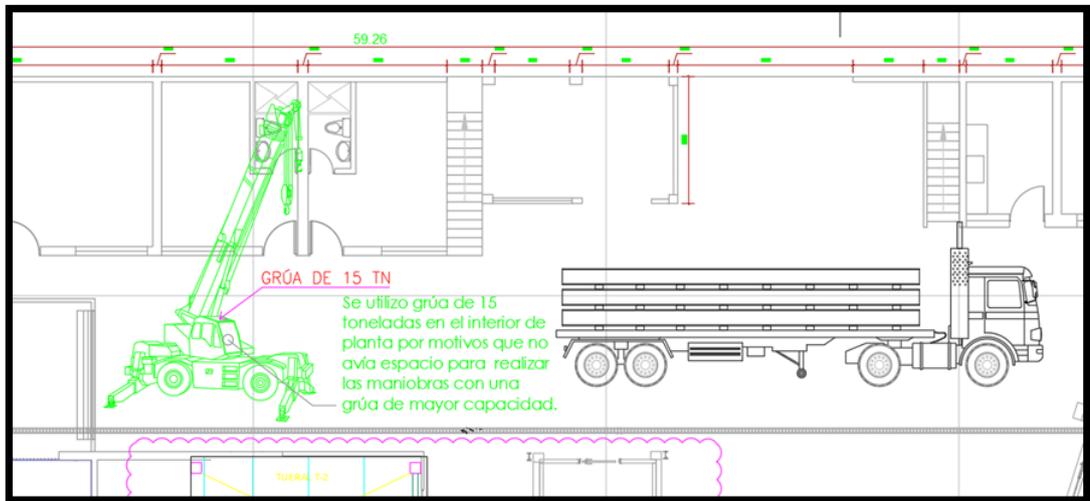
Corte 1 de Layout de Montaje de Estructura Metálica 1er nivel
